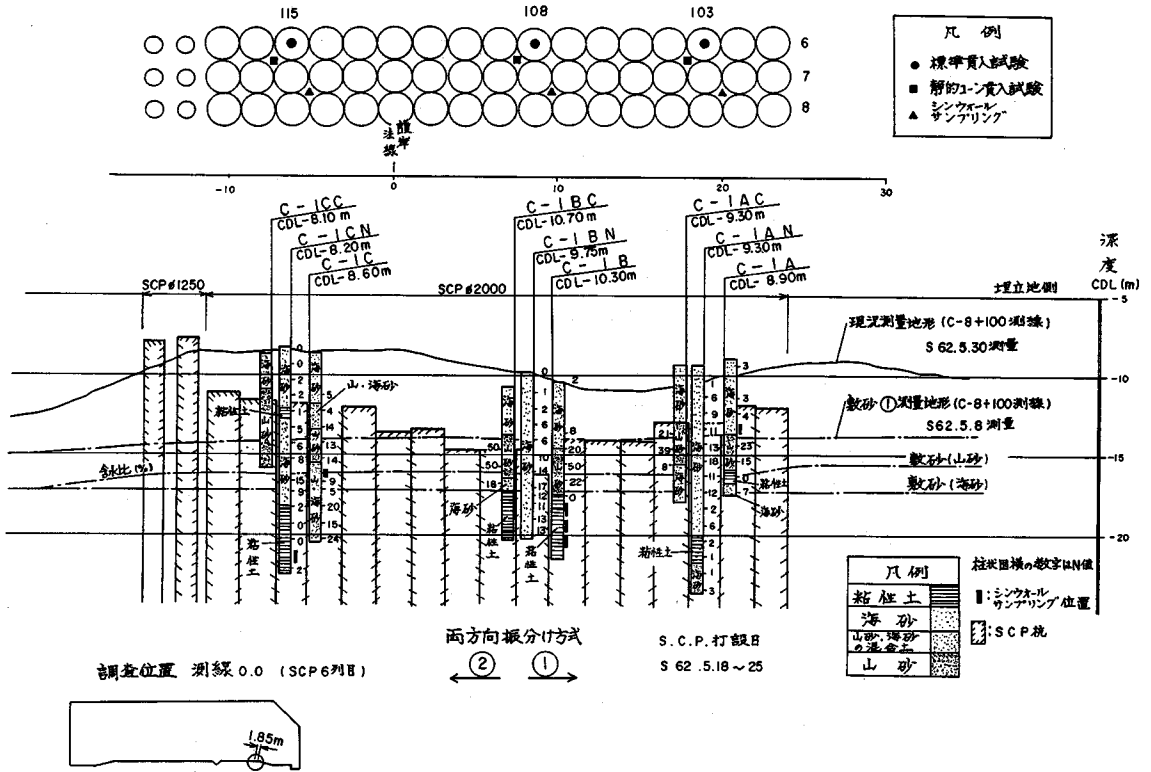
隆起地盤の実測と予測の断面図 (Ⅲ Area)
